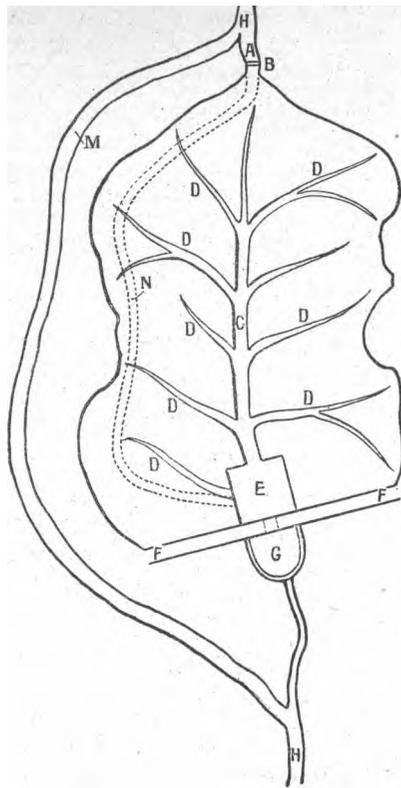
Plan schématique d'un étang d'après M. Raveret-Wattel.
